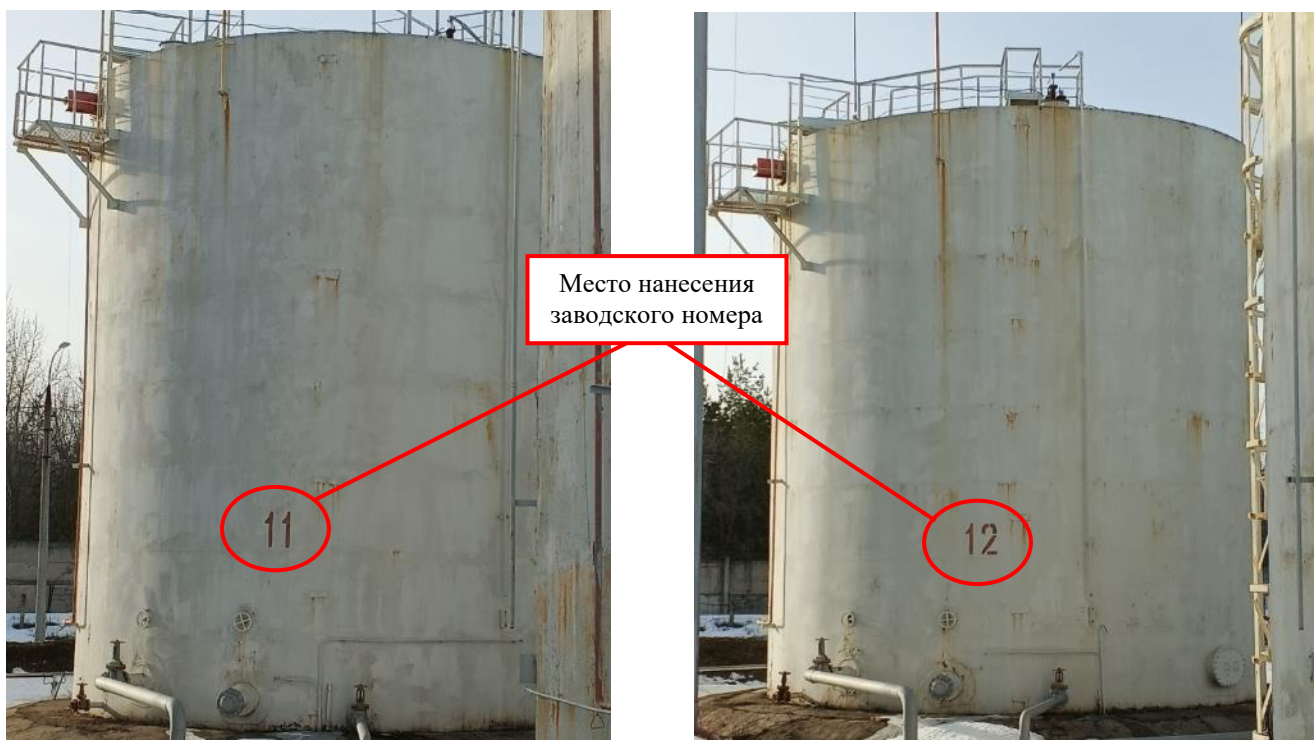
Общий вид резервуара стального вертикального цилиндрического
